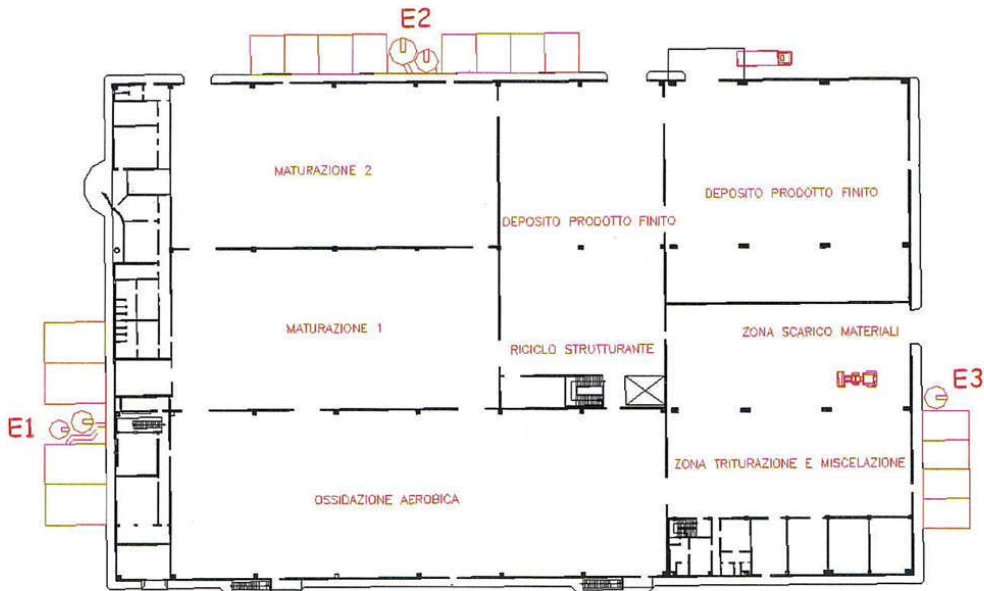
Planimetria con dislocazione delle sorgenti rumorose
